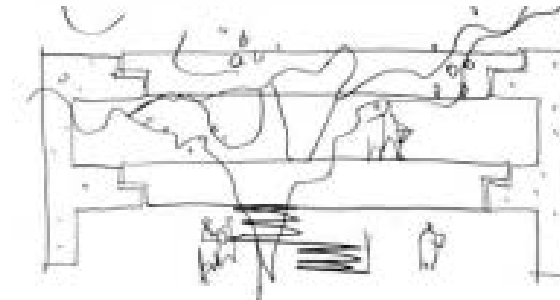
Casa Gerassi }(1989). Prefabricación estructural.
